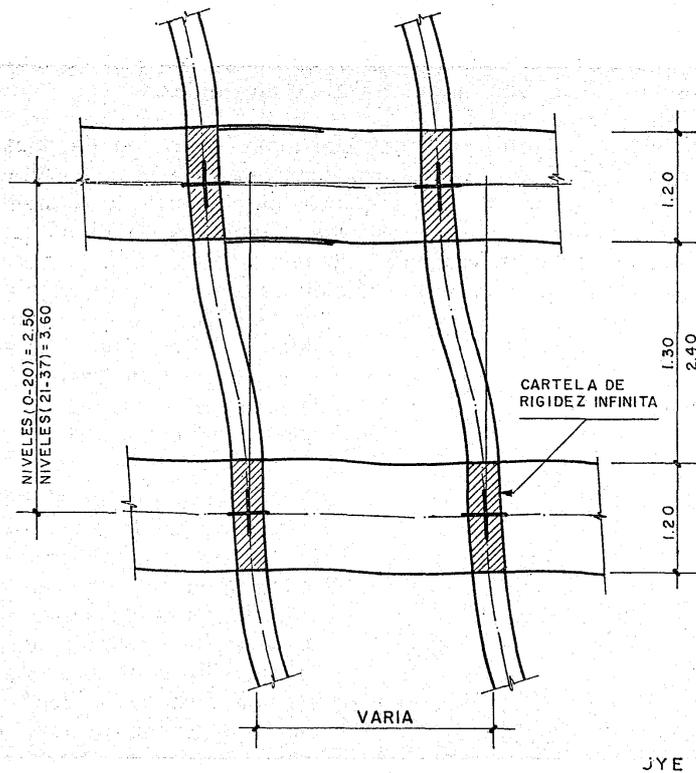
La dimensión de la viga perimetral disminuye la longitud deformable de las columnas. Se reduce así la deformabilidad de la estructura manteniendo sus características dúctiles.
